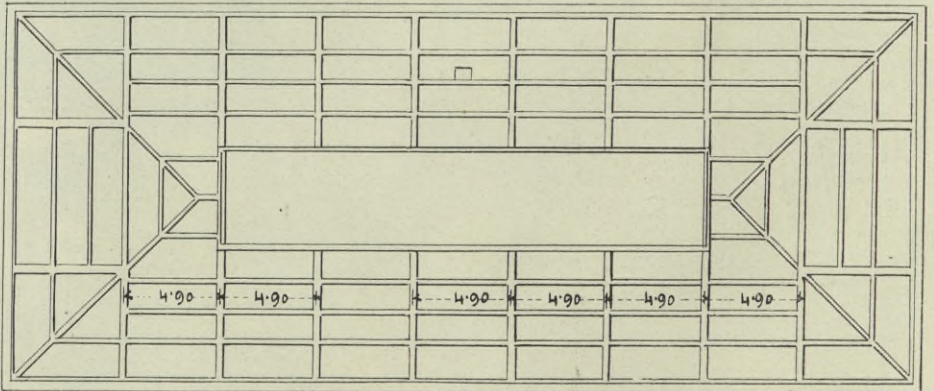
Laboratoriumsgebäude in New-York. Grundriß
